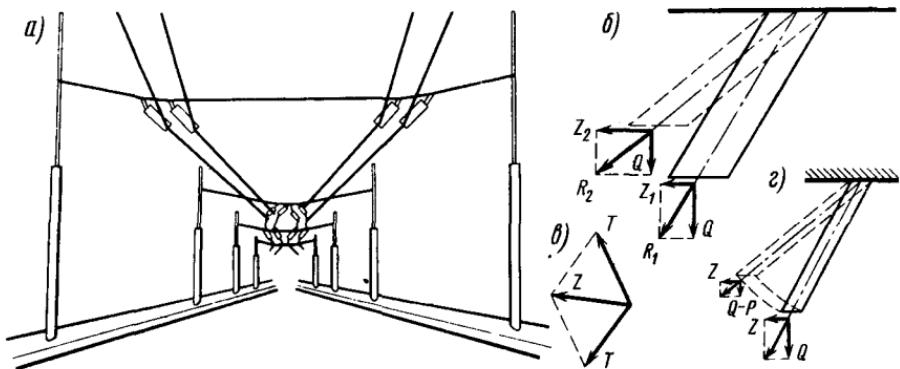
Схема подвески на наклонных струнах (маятниковая):
